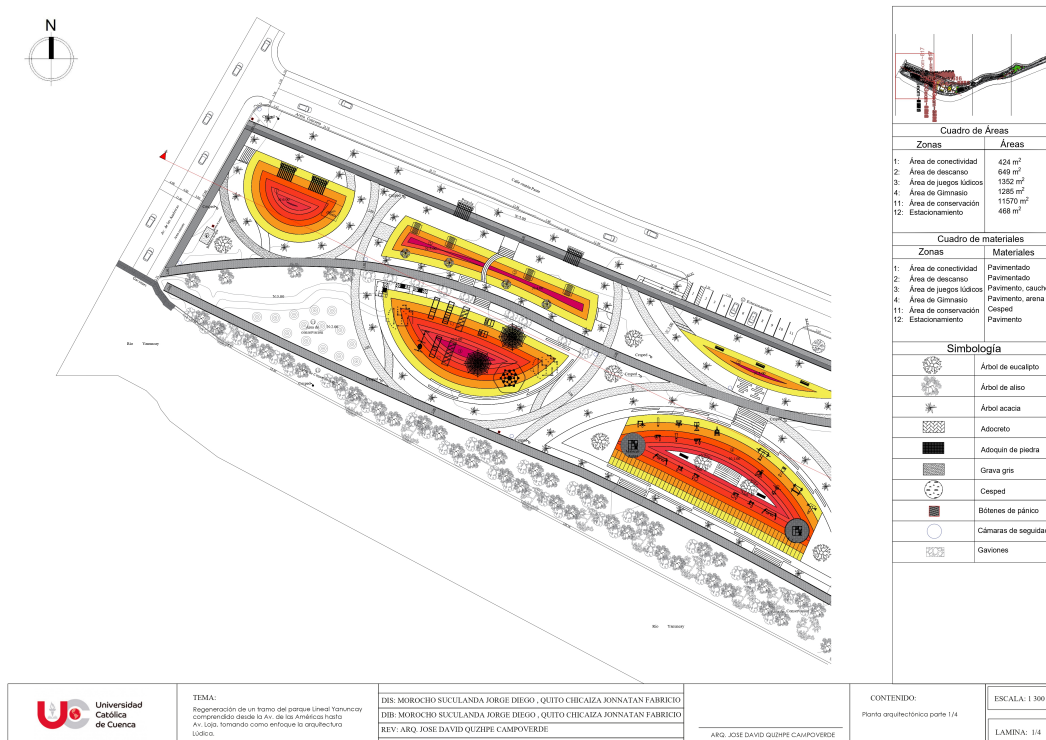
Planta 1 de 4. Fuente : Propia
